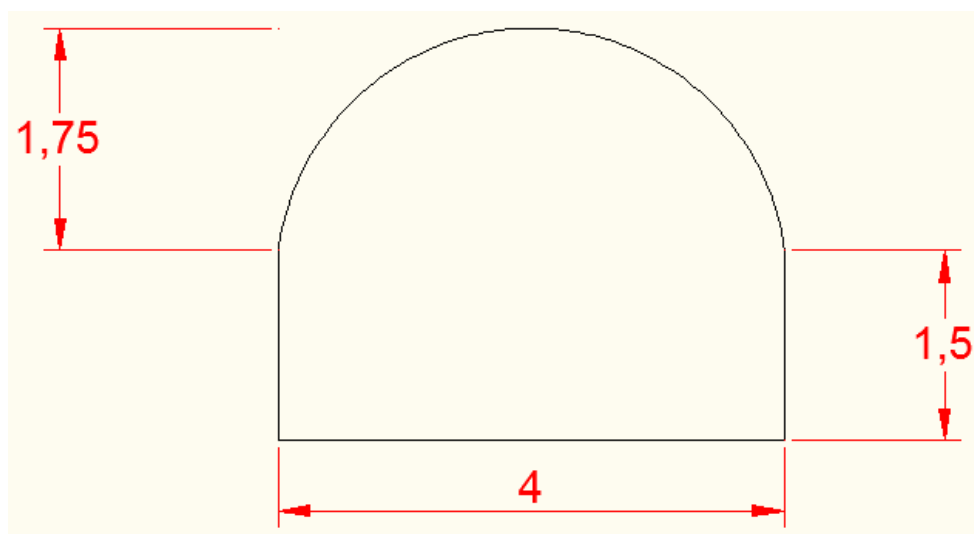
Dimensiones en metros de la galería, vista frontal.
